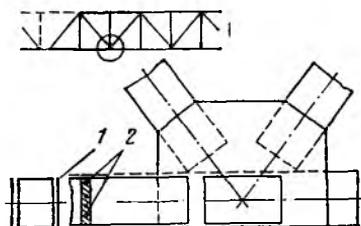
Усиление нижнего пояса накладными элементами:
